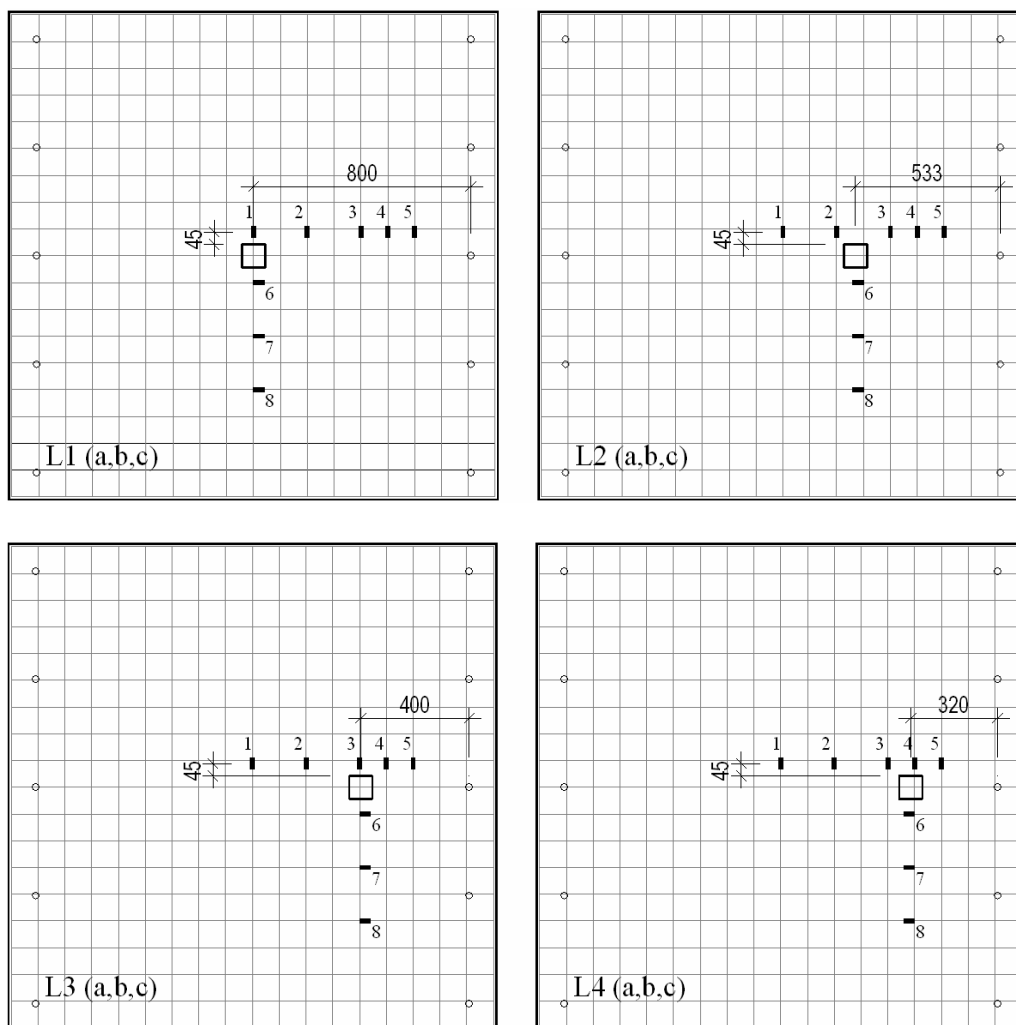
Posicionamento dos extensômetros nas armaduras de flexão
